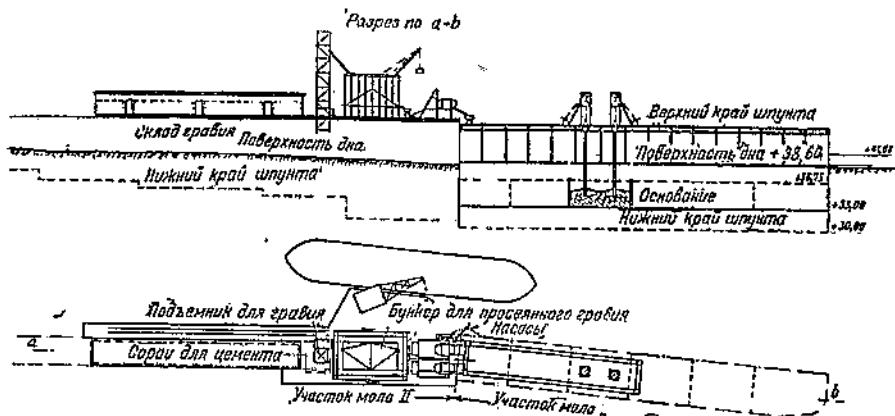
Схема расположения оборудования для укладки подводного бетона в фундаментную плиту мола.
